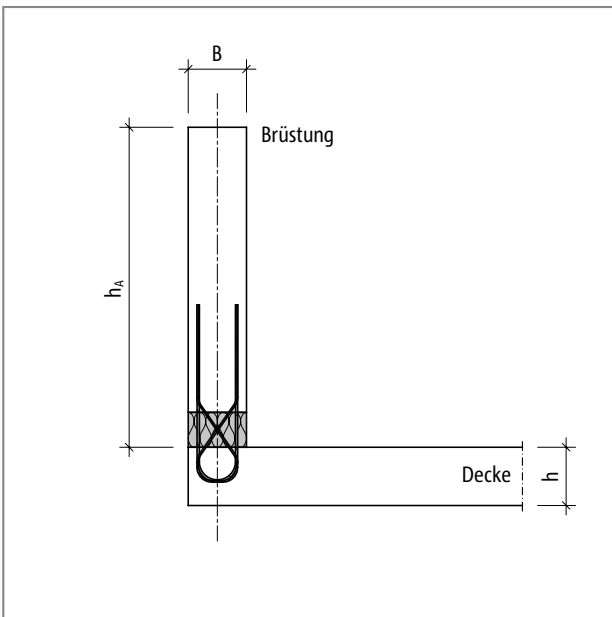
Schöck Isokorb® Typ ABXT: Statisches System Brüstungshöhe h_A
